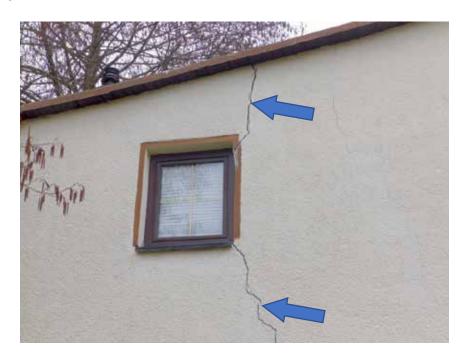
Detailansicht der Fassade (Westseite), mit Setzungsriss
